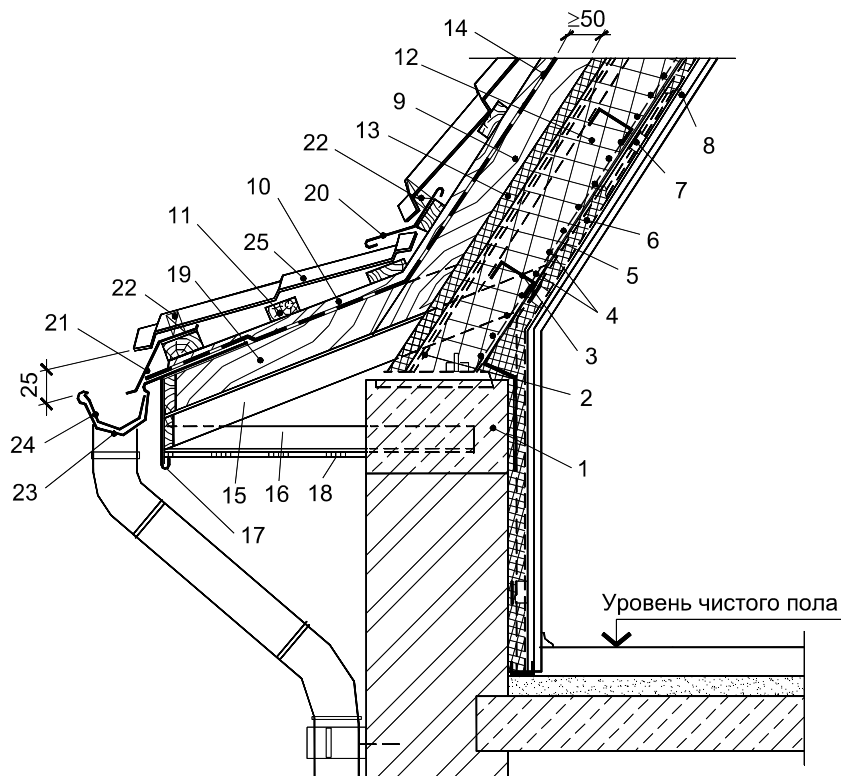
Вариант устройства карниза «теплой» кровли мансардного этажа с водоизоляционным слоем из металлочерепицы
